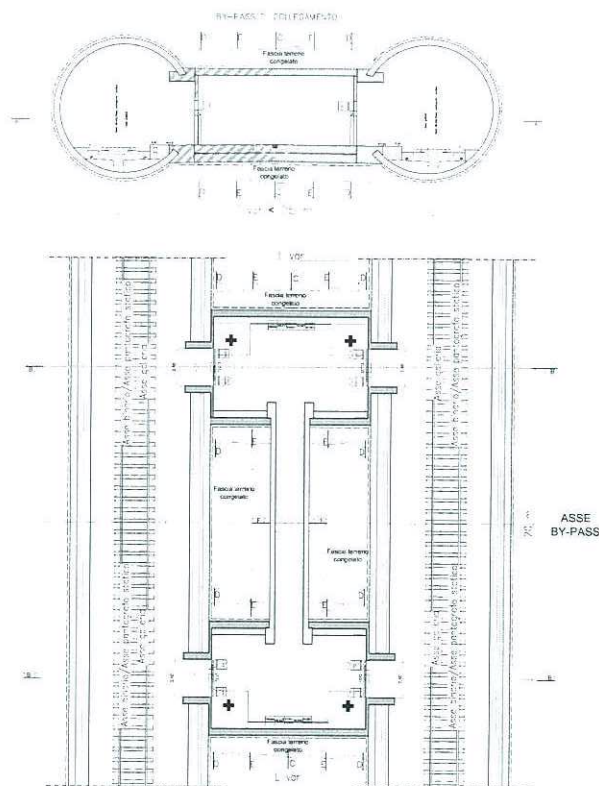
Sezione e pianta dei cunicoli di by-pass nella galleria S.Michele.
